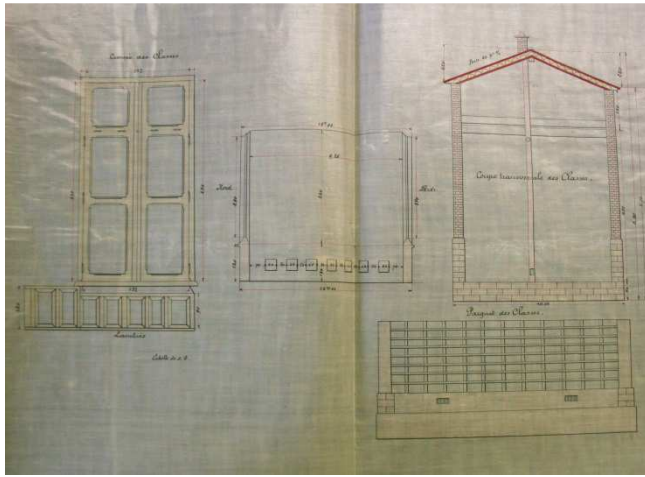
Projet de construction d'un groupe scolaire laïque, plan d'ensemble.
